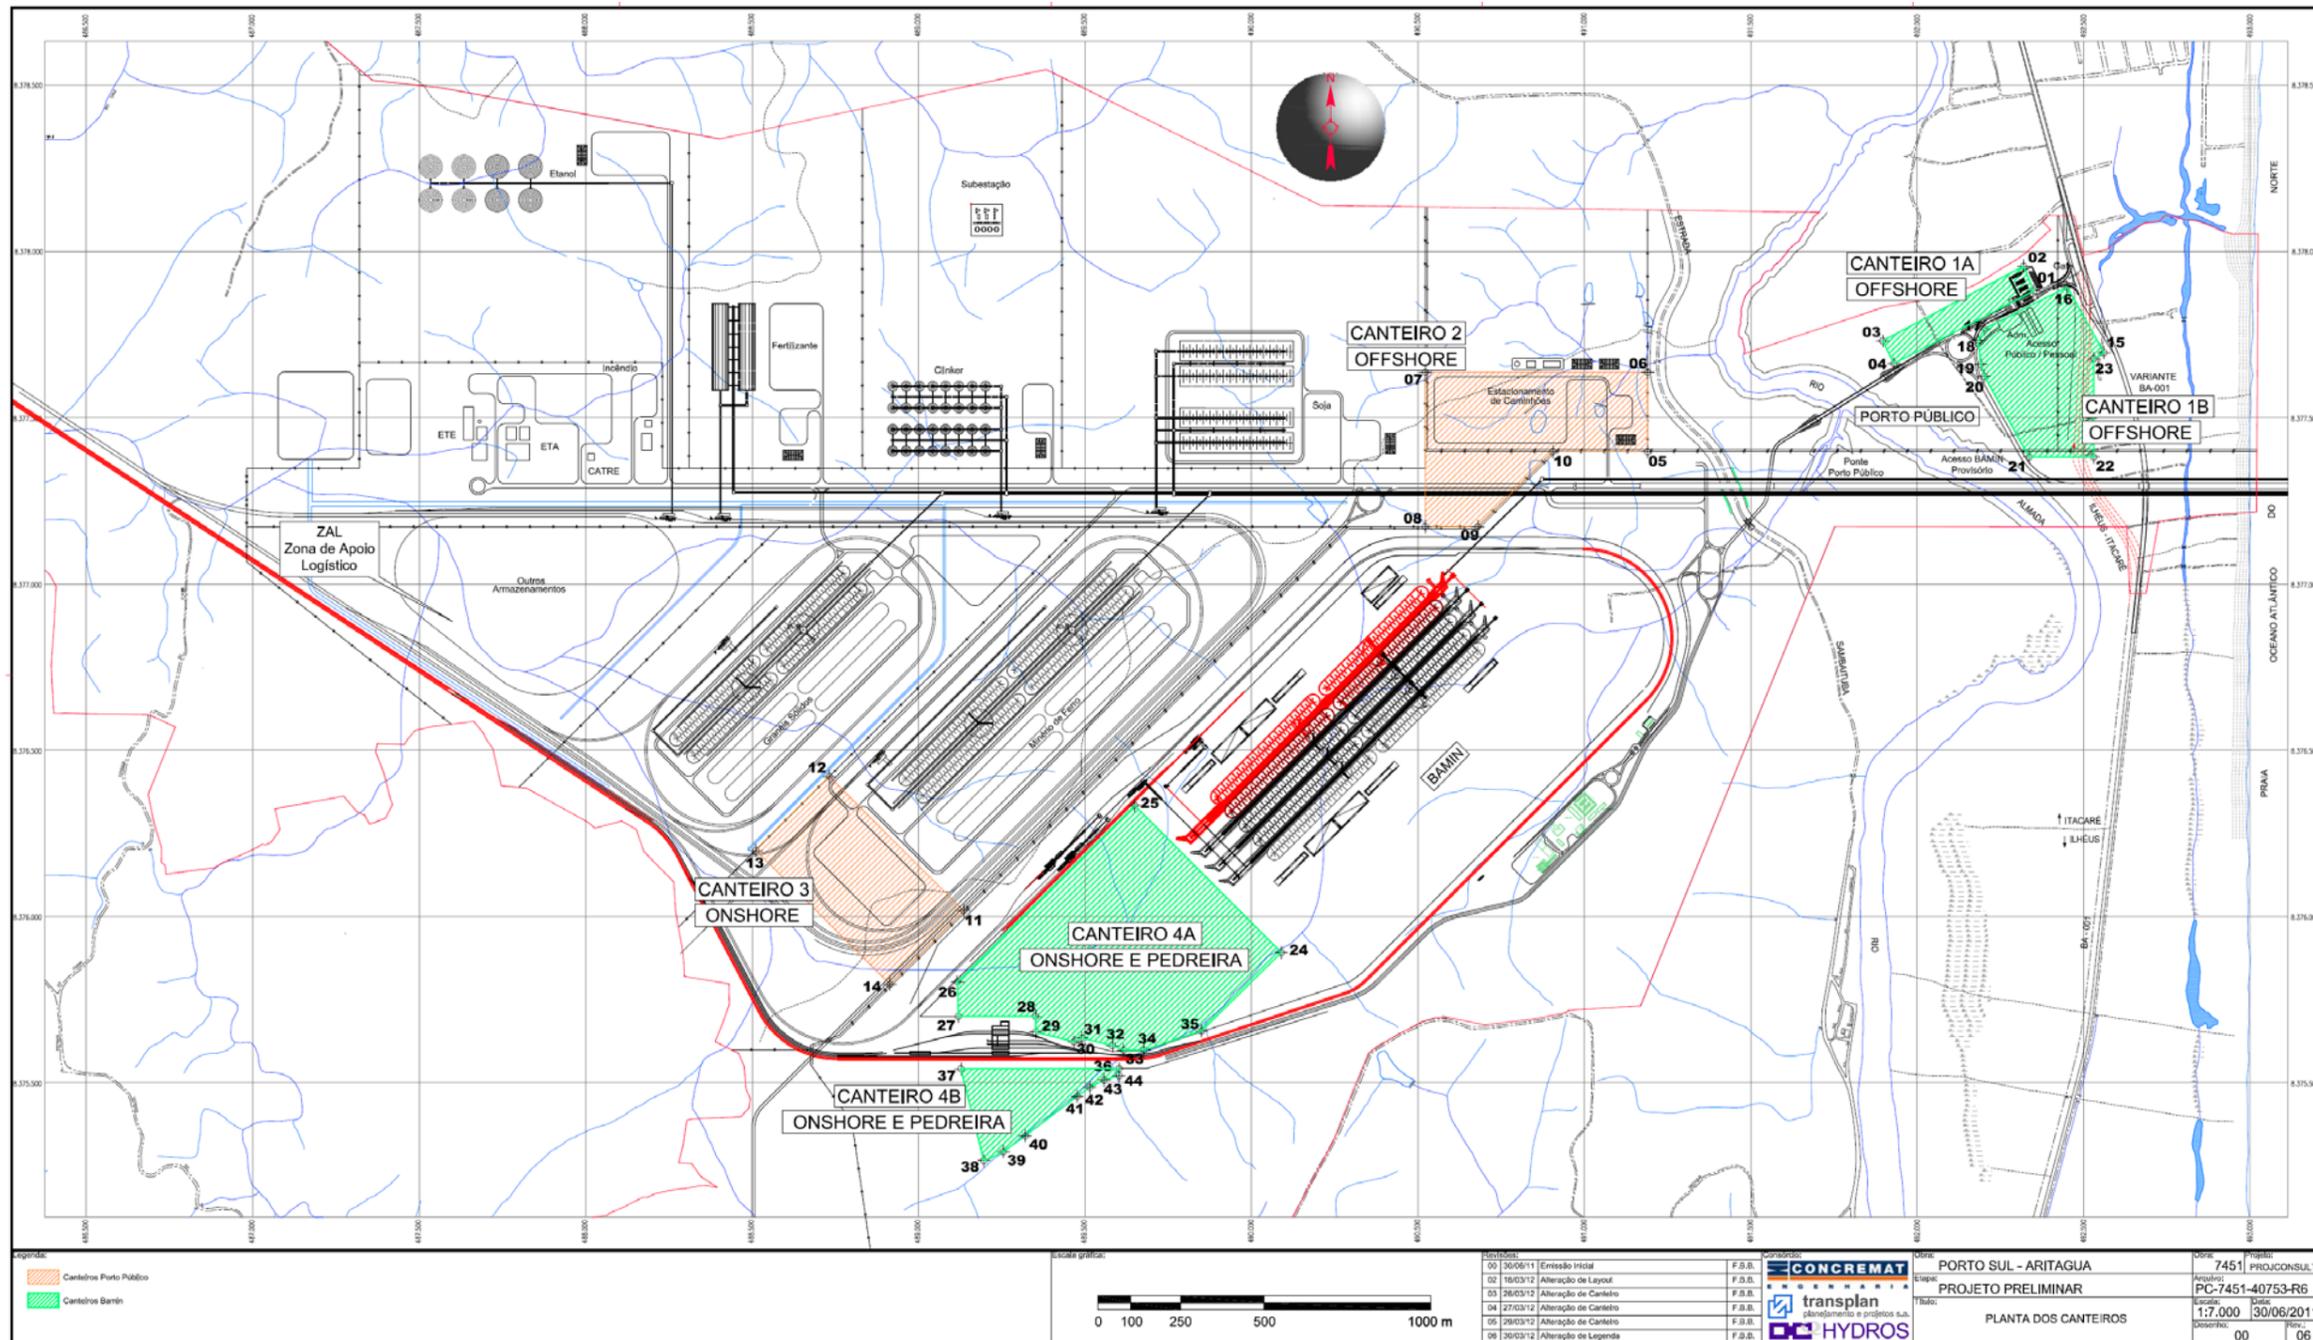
Layout Onshore do Porto Sul – Acesso de Ligação entre a Pedreira Aninga e o Canteiro Offshore do TUP BAMBIM
